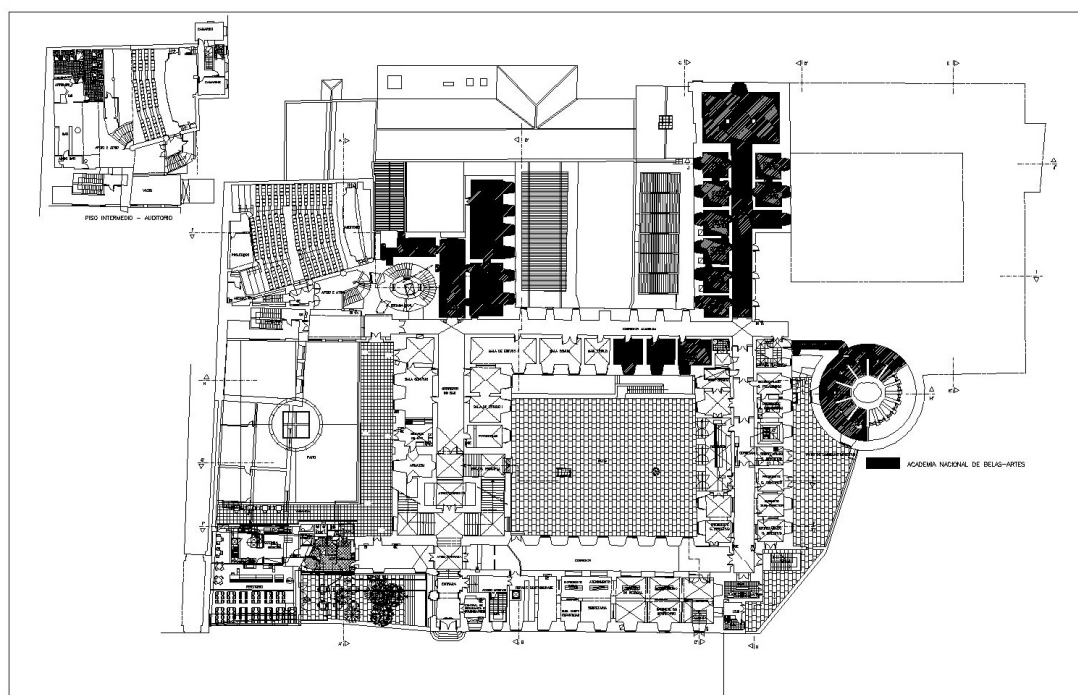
Proyecto para la Facultad de Bellas Artes, por João de Almeida, Pedro Ferreira Pinto y Pedro Emauz Silva (2003). Planta del piso 0. Las zonas oscuras son las ocupadas por la Academia Nacional de Belas Artes. Ver anexos para mayor detalle.
